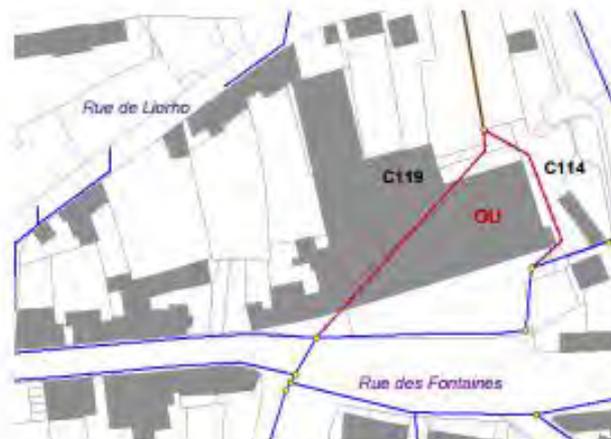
Renforcements proposés pour le secteur de Notre Dame de la Clarté (protection pour T = 10 ans)
